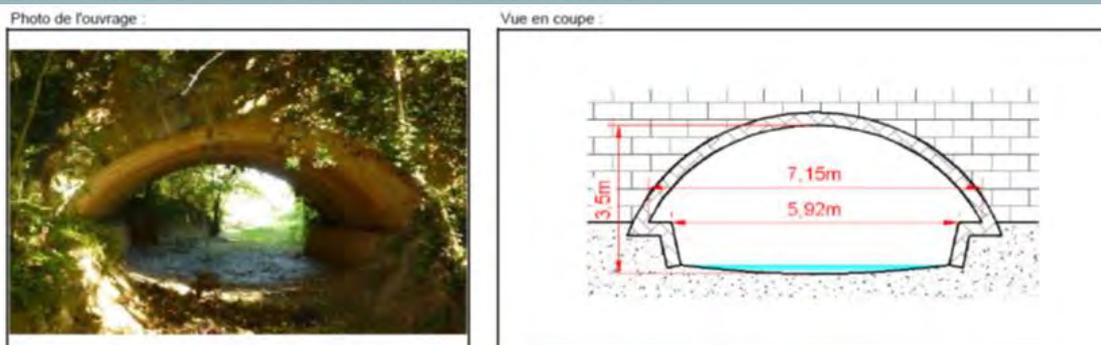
OUVRAGE ET COUPE DE L'OUVRAGE 5B
